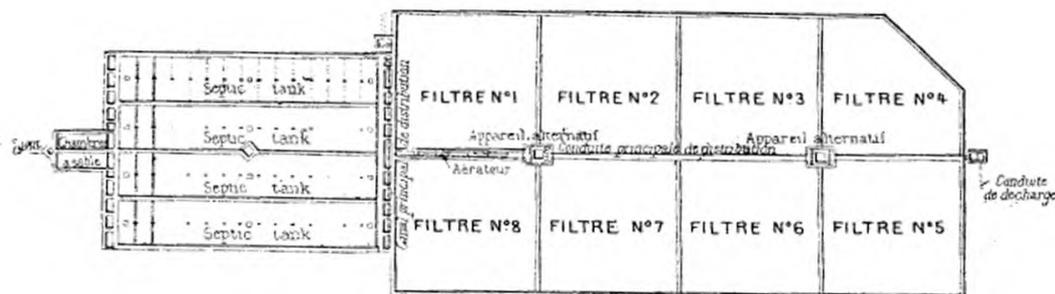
Système Cameron; plan de l'installation de Barrhead.
